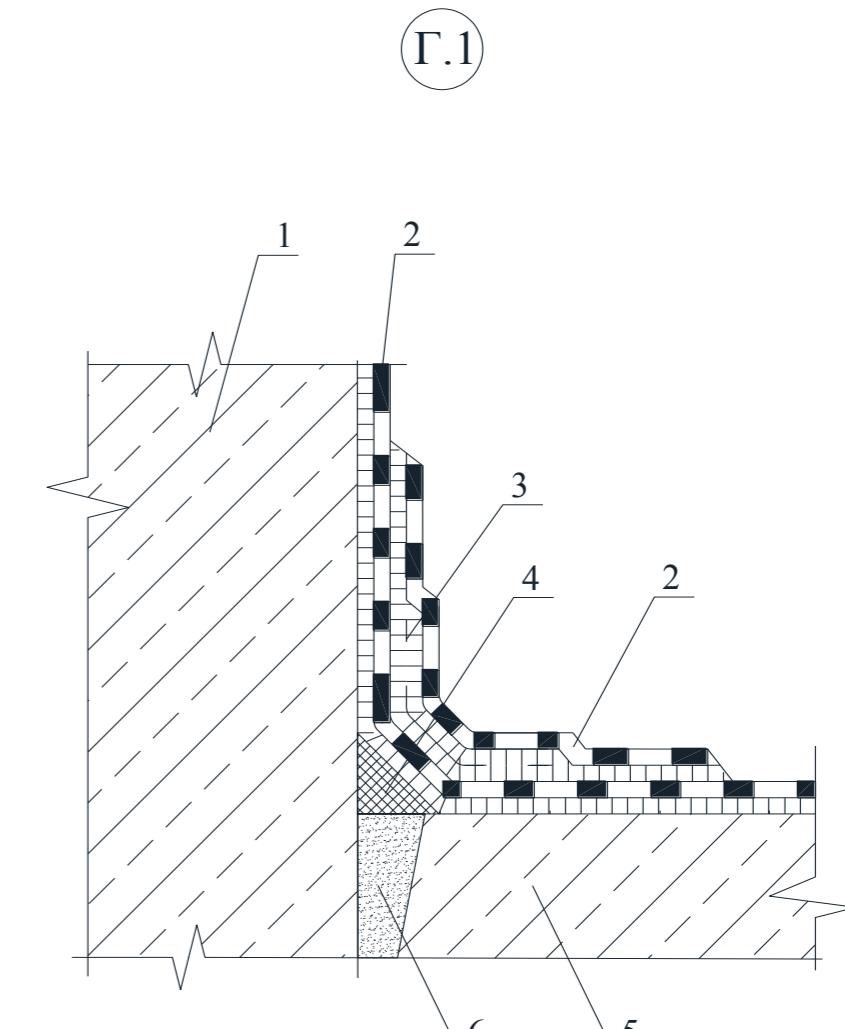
Узел Г.1 Сопряжение места внутренняя часть стены/фундаментная плита подземных конструкций градирни
